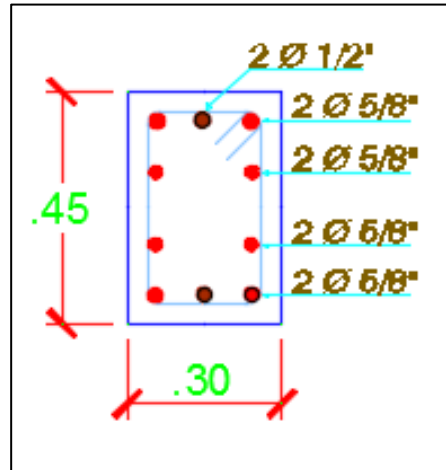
Sección Transversal Viga principal VP - 1. Fuente: Elaboración propia.
